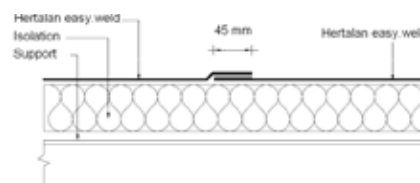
Assemblage par recouvrement longitudinal Hertalan easy.weld
